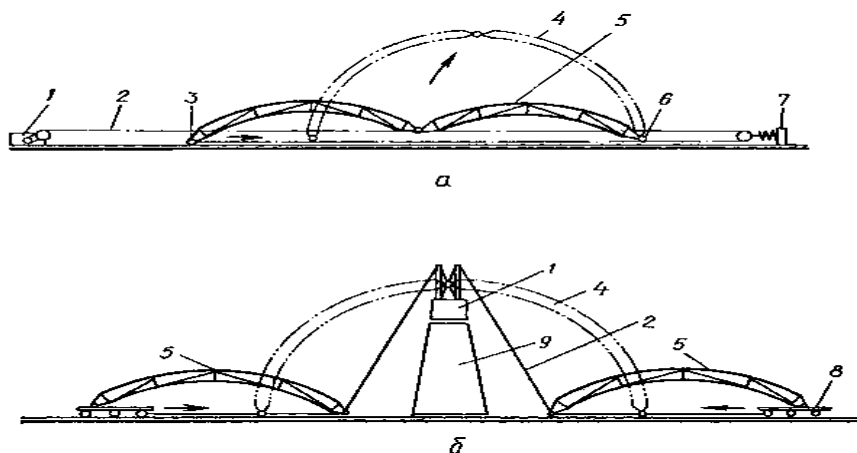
Монтаж арок стягуванням опор: а – нижніх; б – верхніх; 1 – лебідка; 2 – трос; 3 – рухомий шарнір; 4 – проектне положення арки; 5 – положення арки перед підніманням; 6 – нерухома опора; 7 – анкер; 8 – візок; 9 – тимчасова опора
